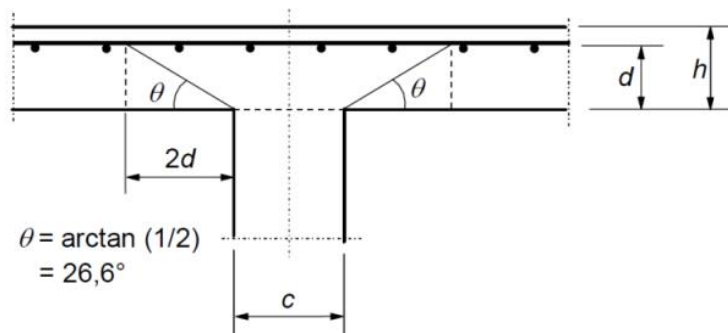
Inclinação das fissuras de cisalhamento. [modificado – EUROCODE 2:2004]
